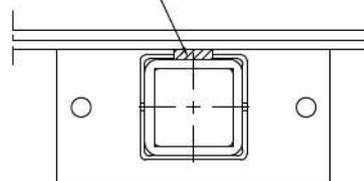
fissaggio del fermapiEDE con il montante attraverso un piatto da 5mm di spessore per la rimozione del parapetto
